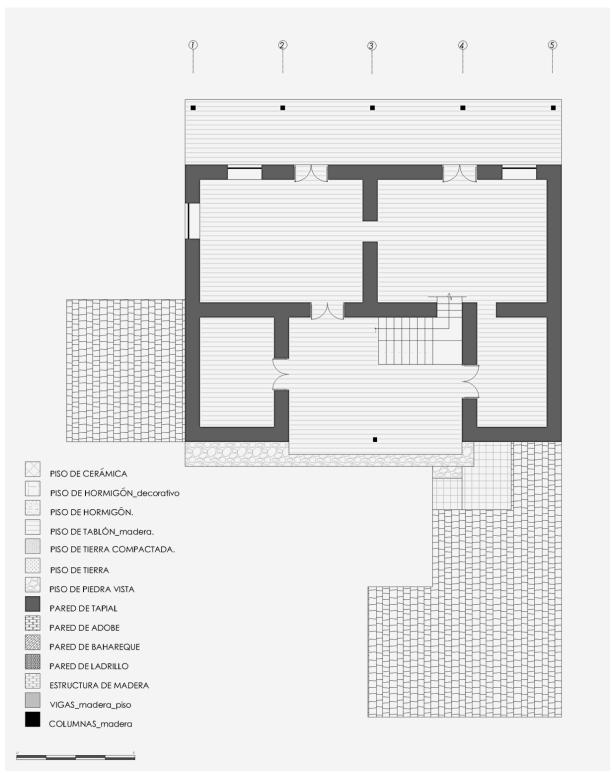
Planta arquitectónica (3°), vivienda de un poblador extranjero 002
